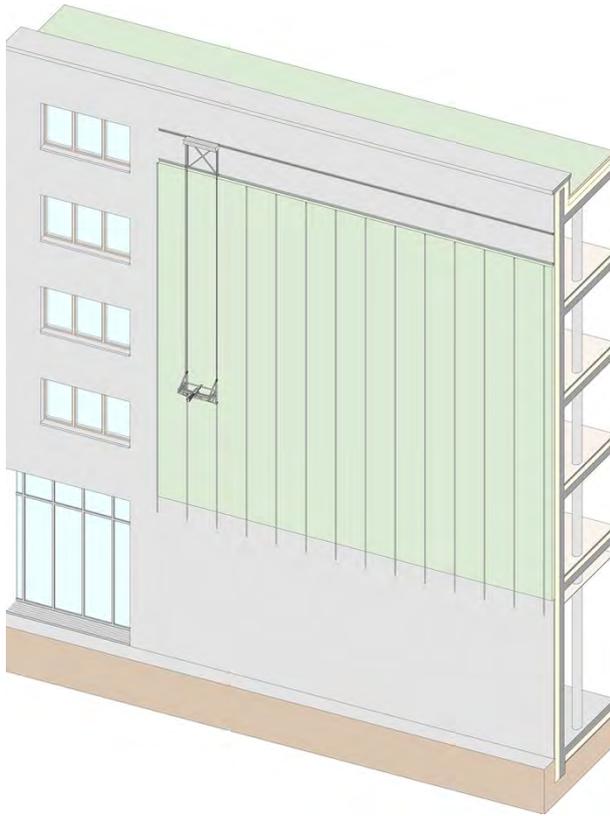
Fallstudie Grünfassade mit eingerückter Teilfläche, Begrünung wandgebundenes System (flächige Konstruktion, Ausführung VHF, Portalbauweise (Axonometrie). Bild: Fakultät Architektur
